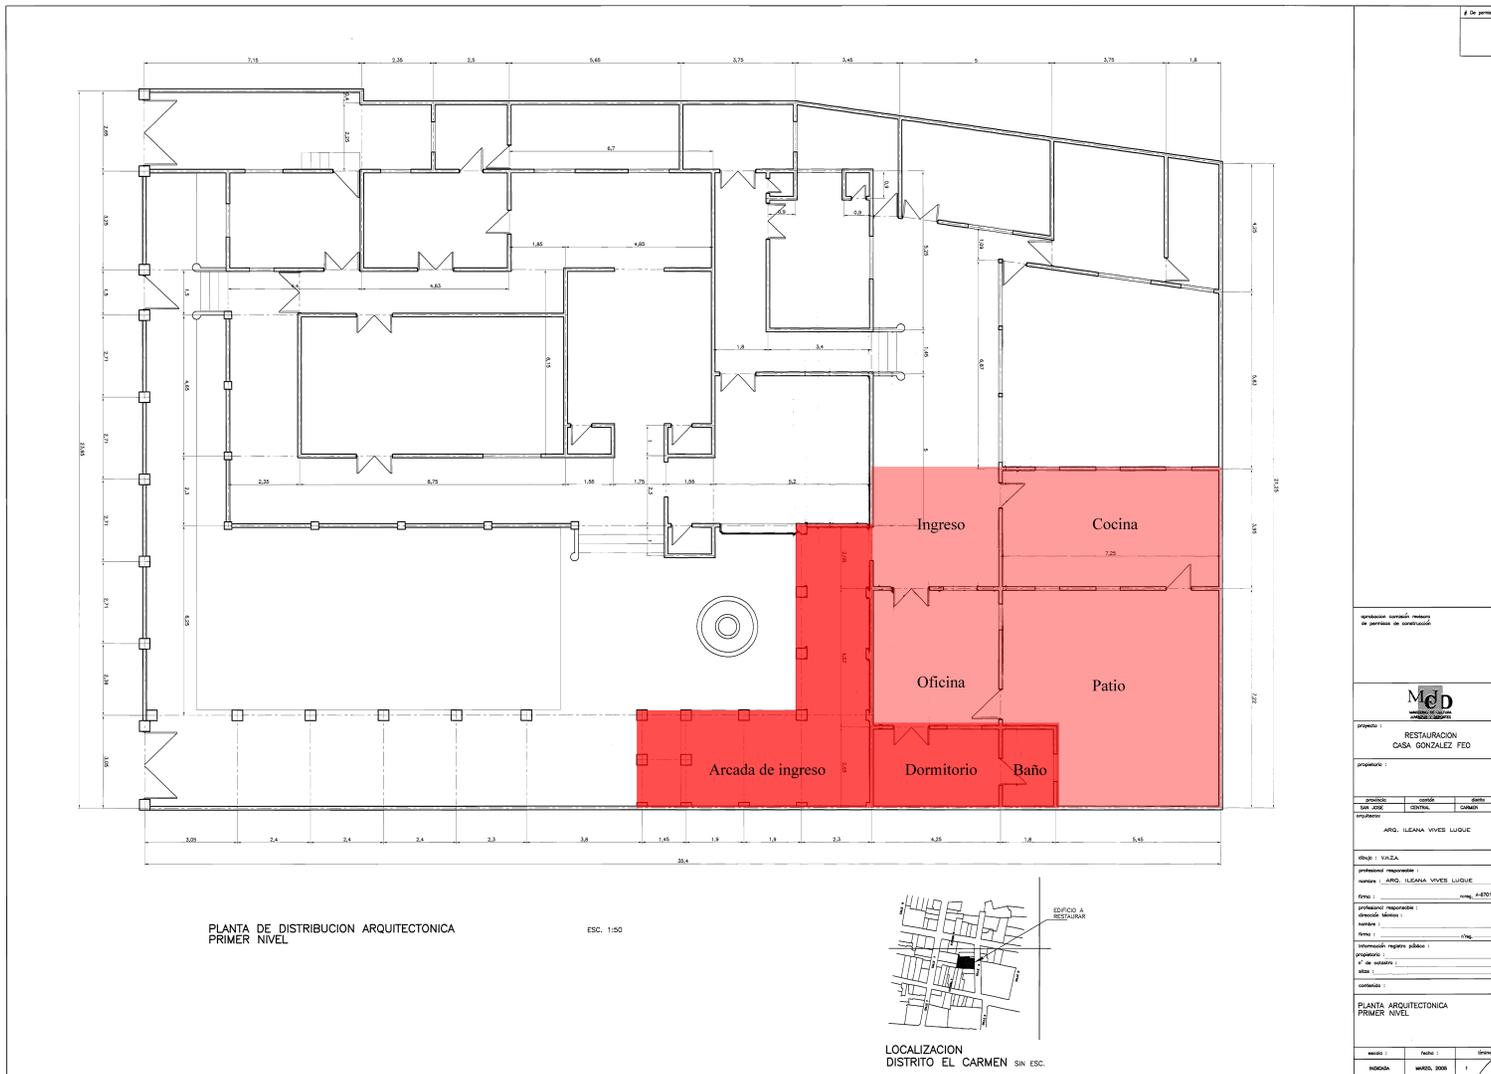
Planta primer nivel, Casa González Feo y área del proyecto PI_CGF_001_2018.
